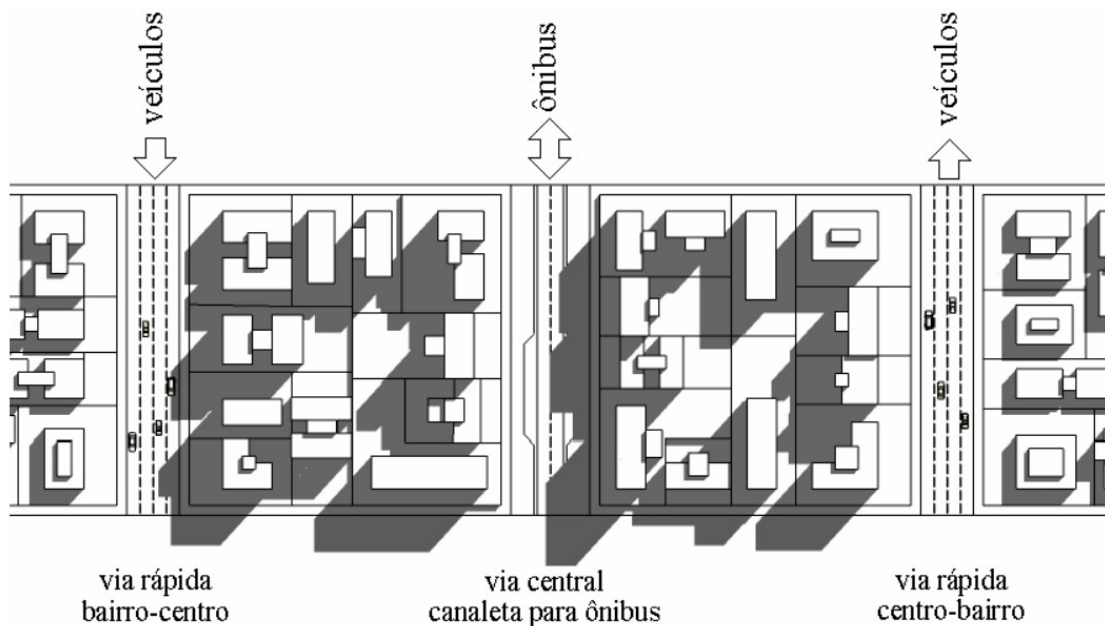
PLANTA SISTEMA TRINÁRIO
